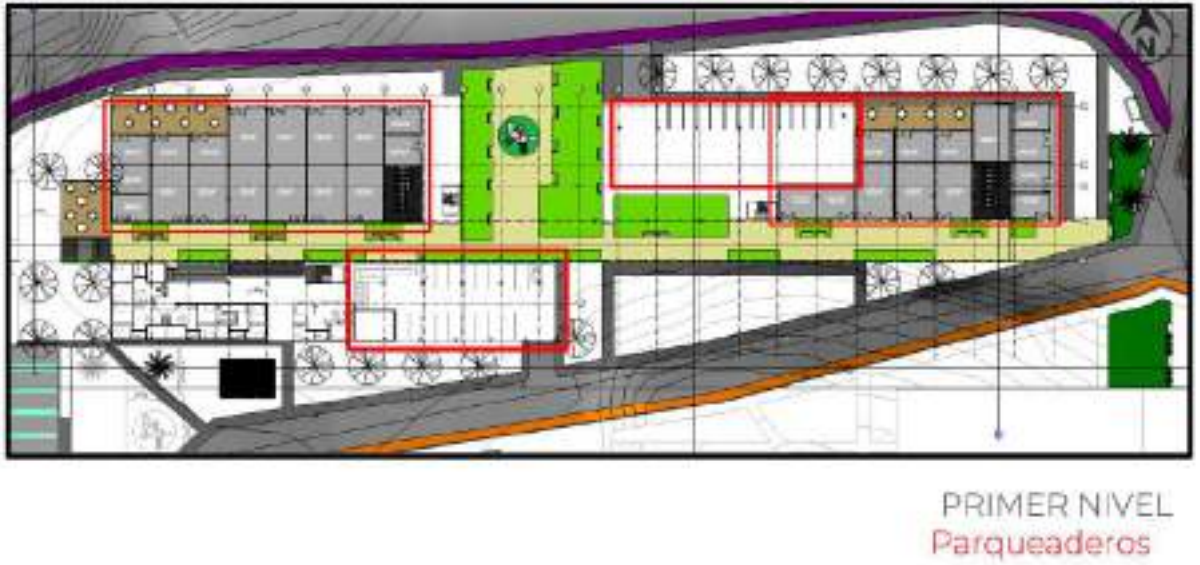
Propuesta de Parqueaderos- elaboración Propia
